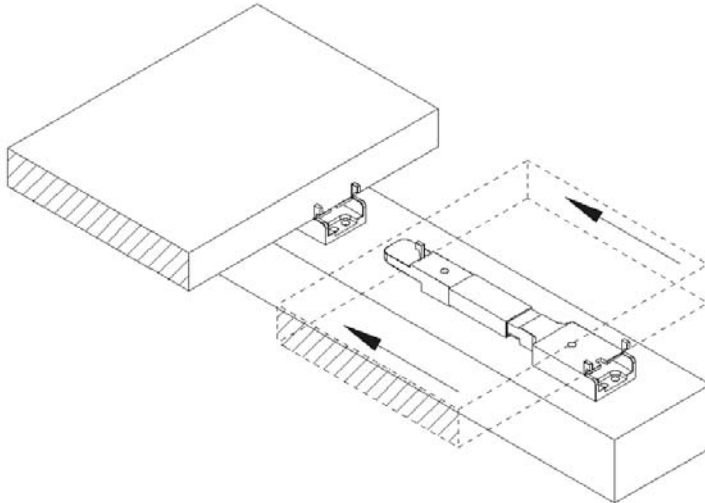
(Quelle: Karle & Rubner) Montage mit Clipper
